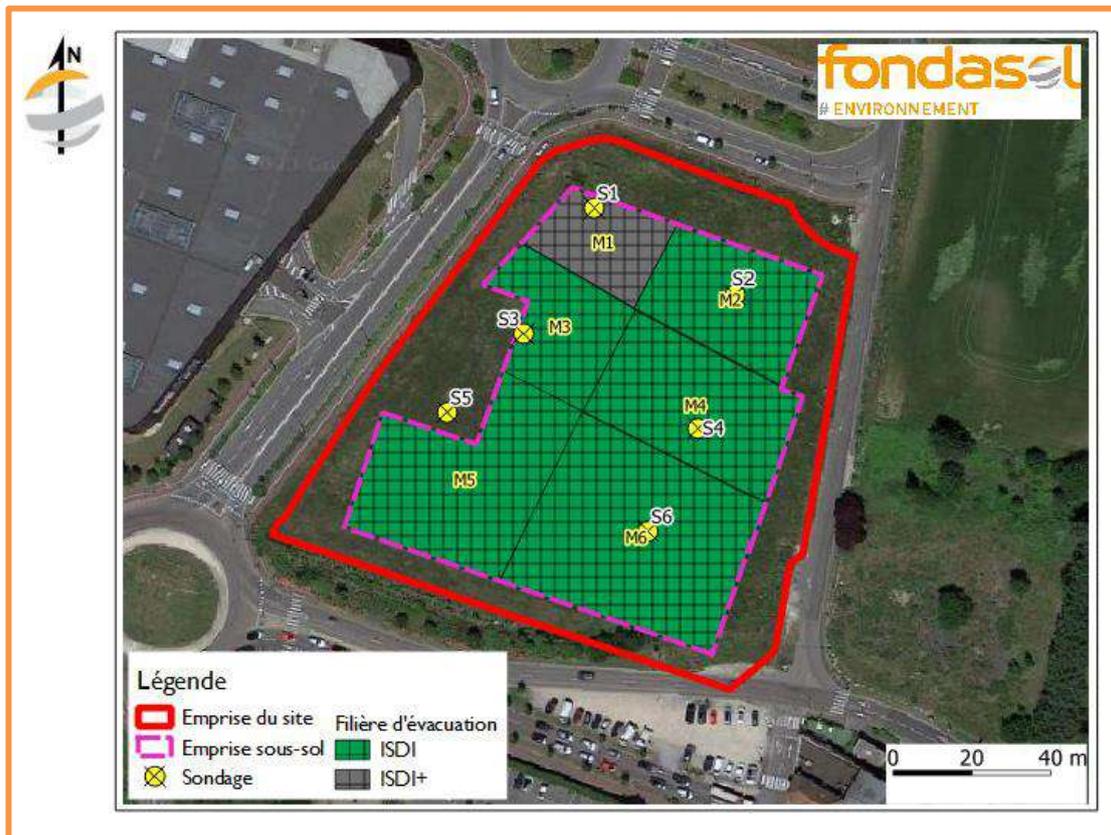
Plan de maillage – entre 8 et 8,5 m de profondeur
